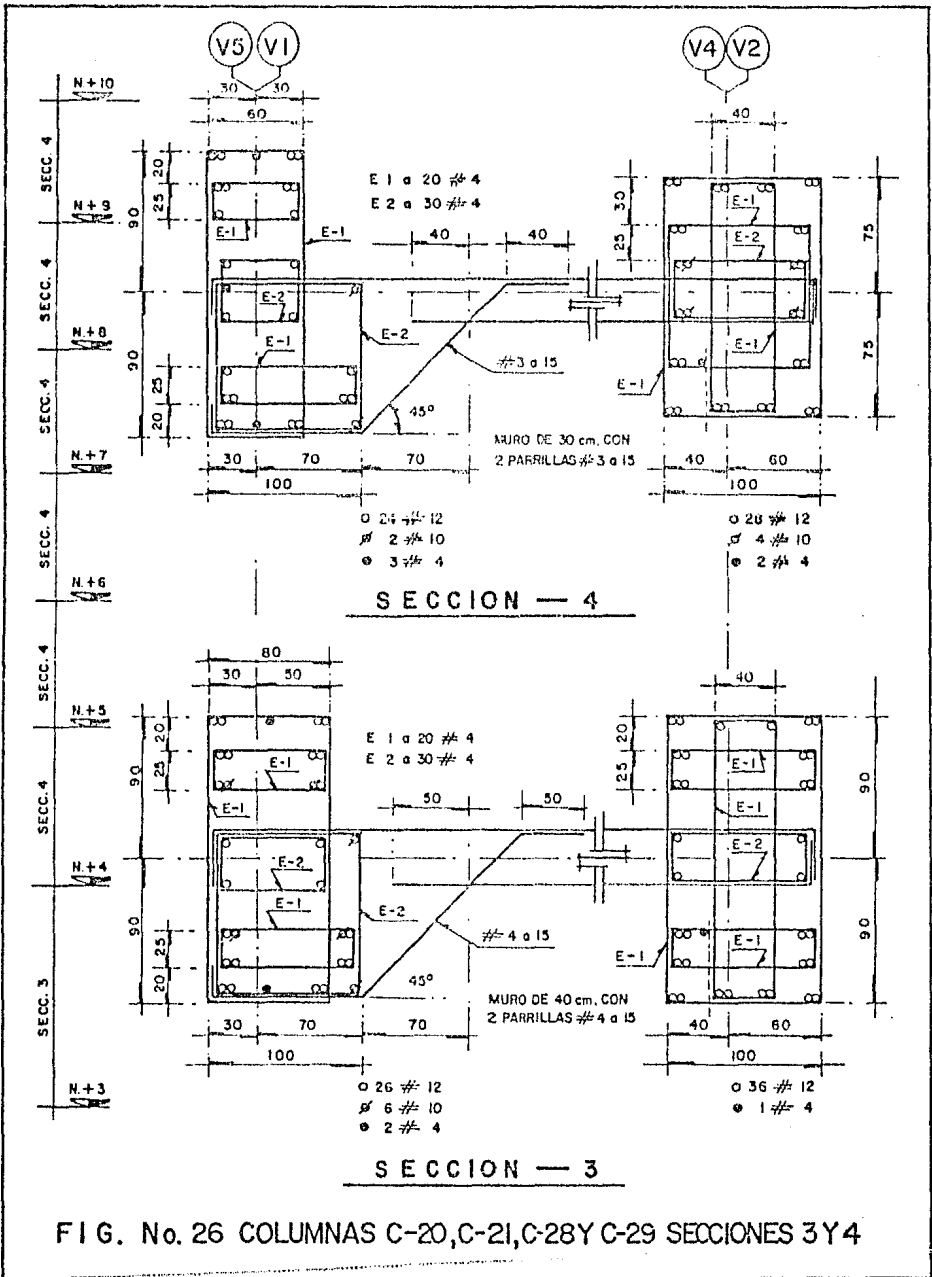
COLUMNAS C-20, C-21, C-28 Y C-29 SECCIONES 3 Y 4
